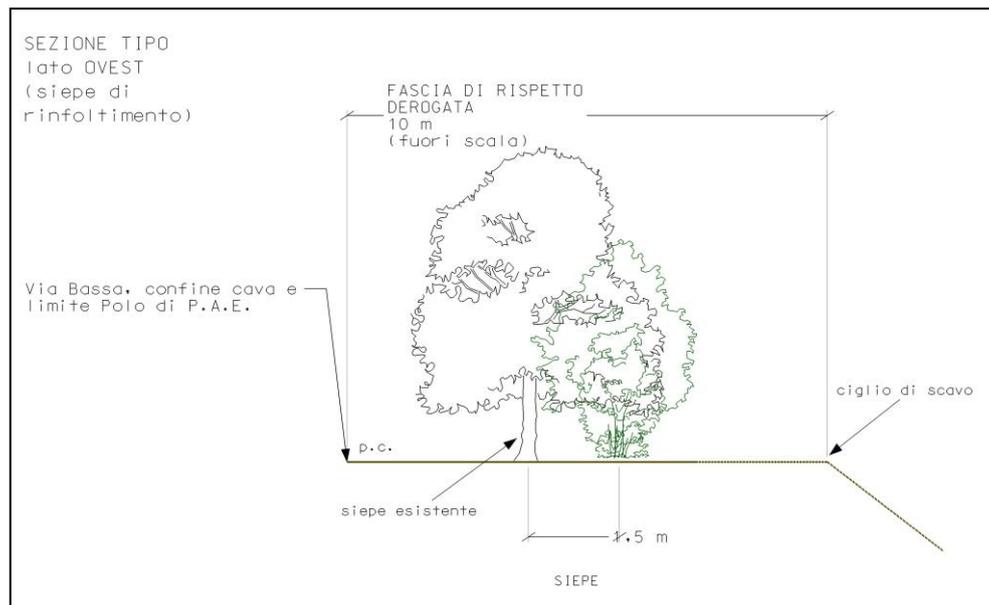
Sezione tipo della siepe monofilare di rinfoltimento sul lato Ovest.
